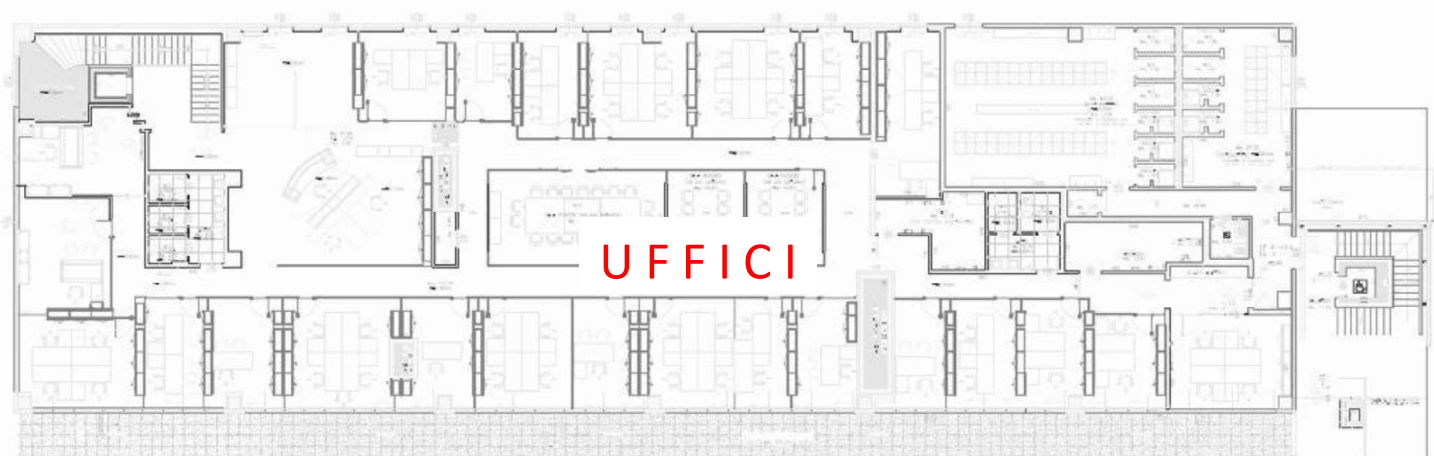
Sito via della Punta 21-23 - Planimetria primo piano: uffici
